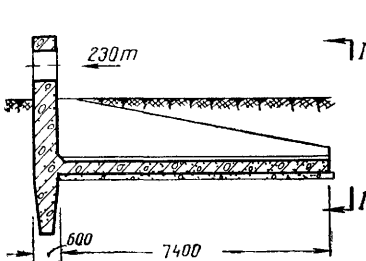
Неподвижная опора из монолитного железобетона при низкой прокладке трубопроводов
